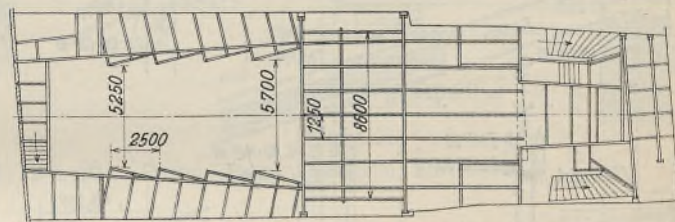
Aufsicht über dem Rang mit Trägerlage.
